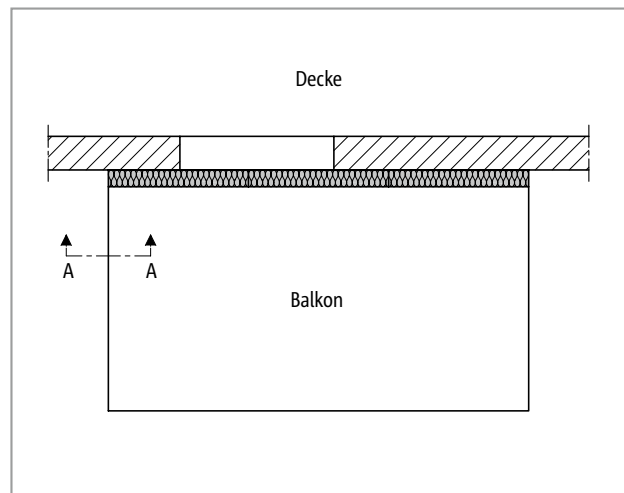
Schöck Isokorb® XT Typ K: Darstellung der Lage von dem Schnitt A-A
